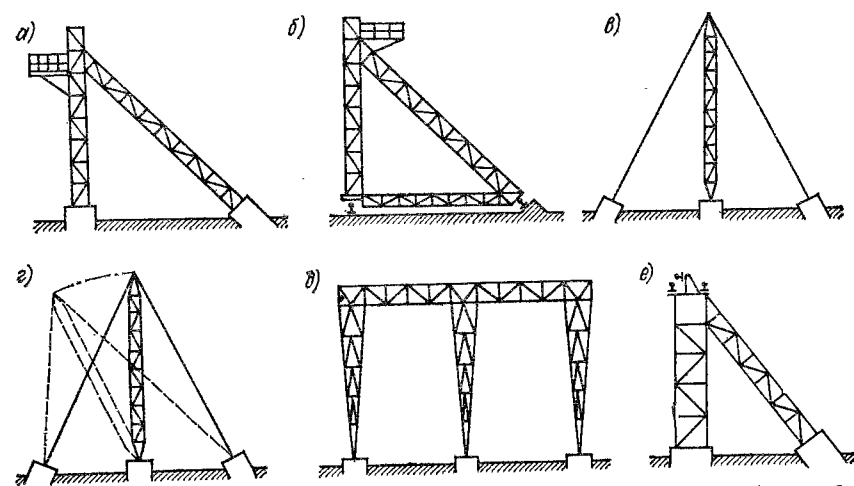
Схемы башен и опор кабельных кранов: а — неподвижная башня; б — подвижная башня; в — мачта на расчалках; г — отклоняющаяся мачта; д — порталый опора; е — опора подкрановой эстакады
